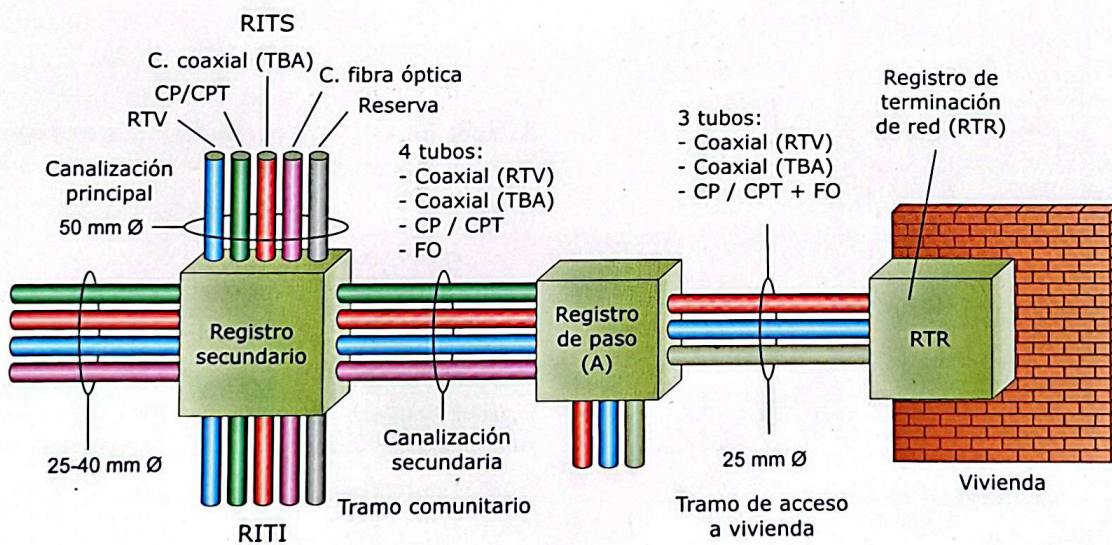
Canalización secundaria para 6 o más PAU por planta.
